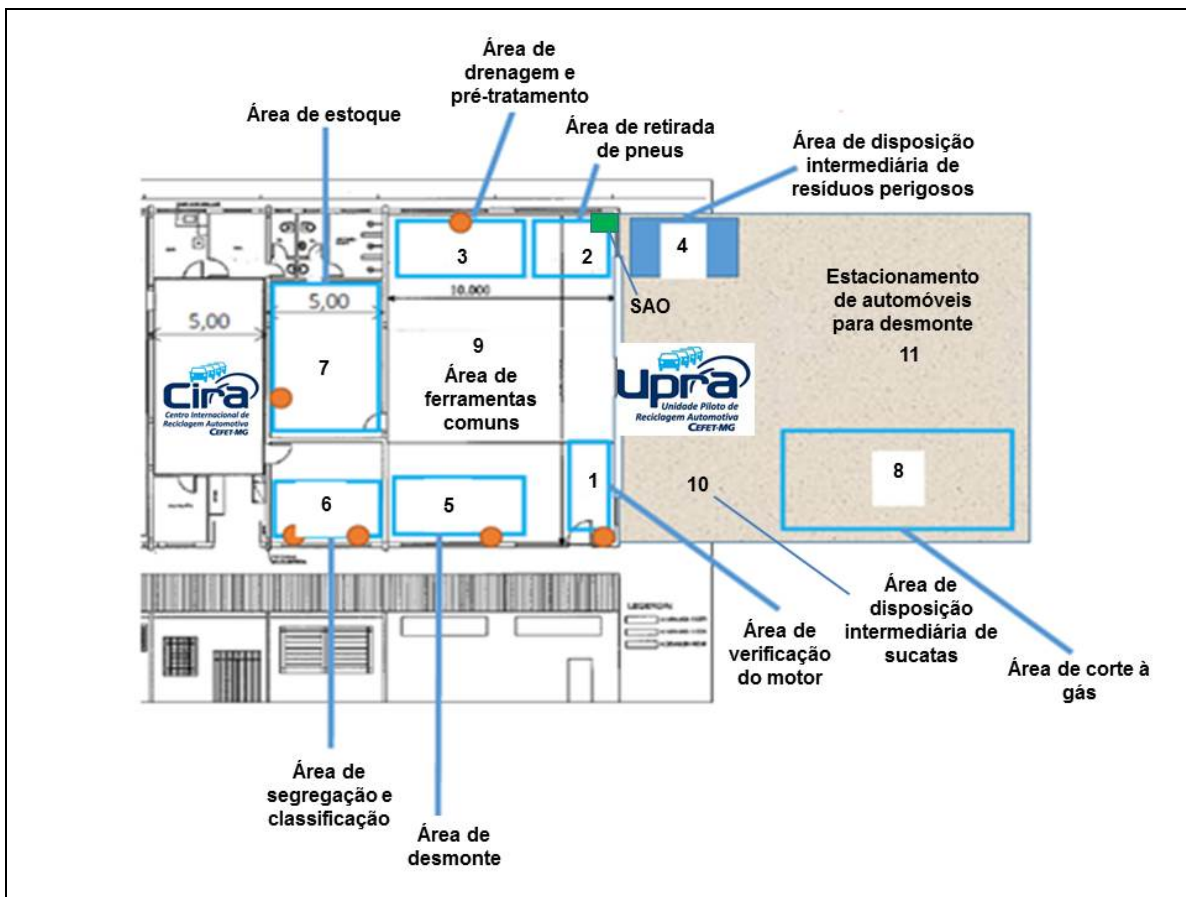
Planta baixa com corte - Áreas operacionais da UPRA.
